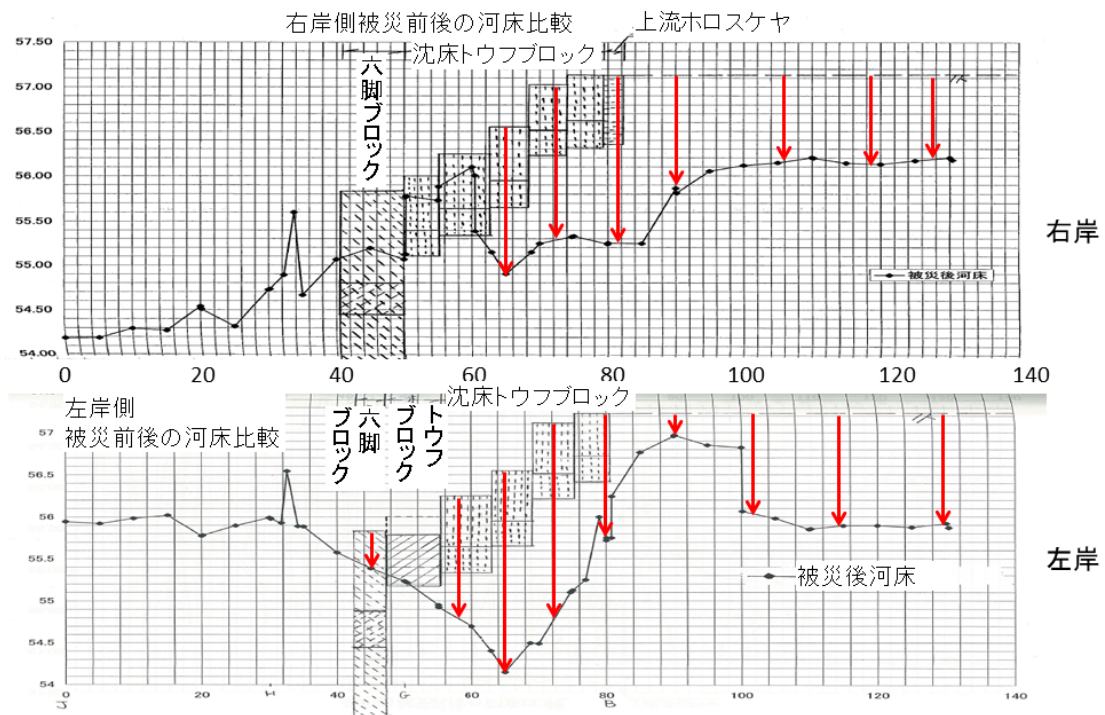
M 床固め工被災後最深河床高縦断面図 (床固め工前後)
